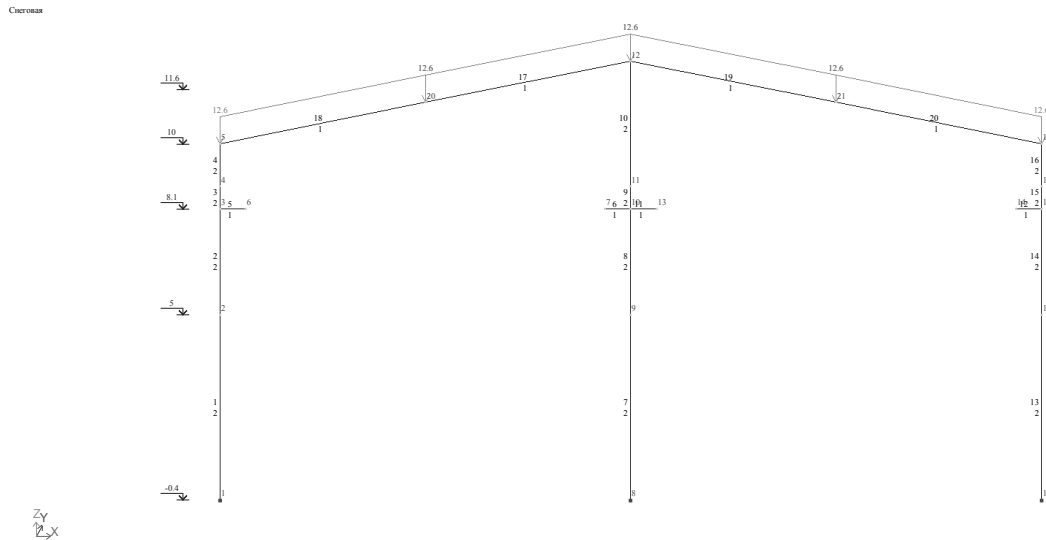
Схема нагружения поперечной рамы снеговой нагрузкой
